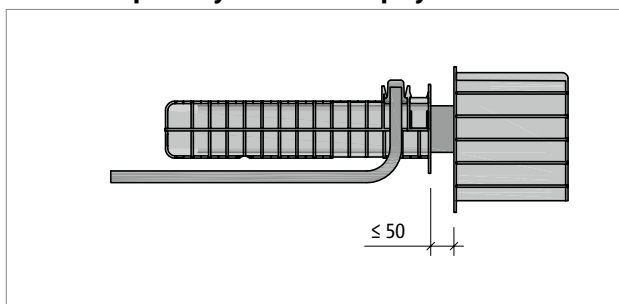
Schöck Tronsole® typ Q: Varianta s vodorovnou polohou nosného profilu
